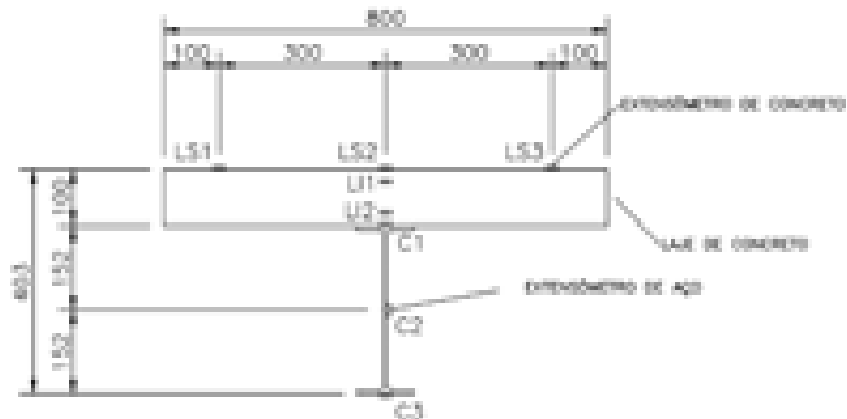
Posicionamento dos extensômetros elétricos na seção transversal central da viga mista
